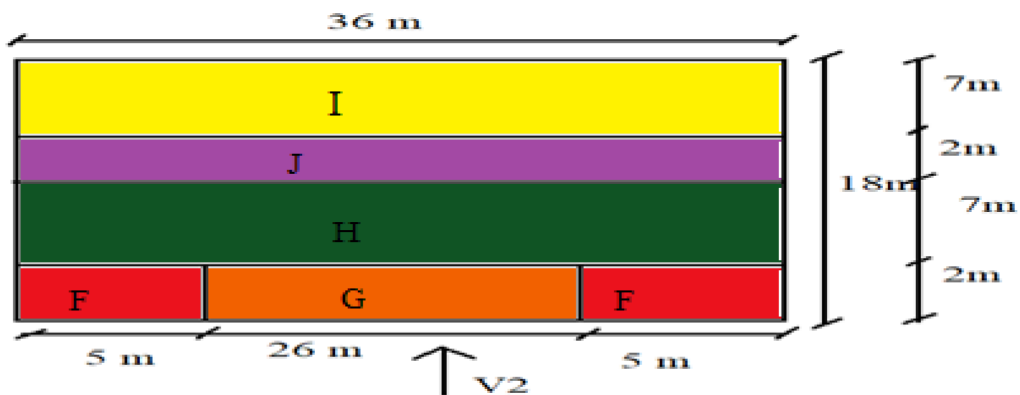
vue en plan des zones de pression sur les parois vertical  $V_2$
